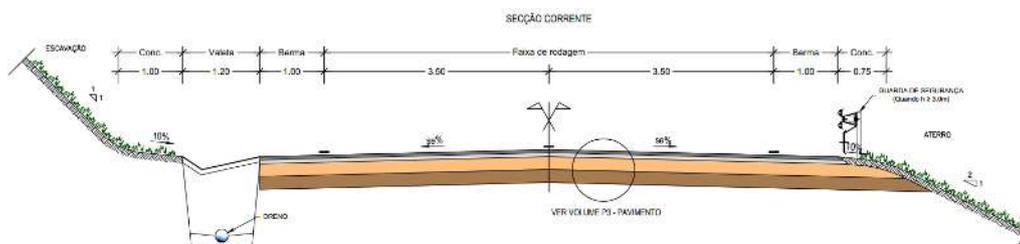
Perfil Transversal Tipo (Secção Corrente)
